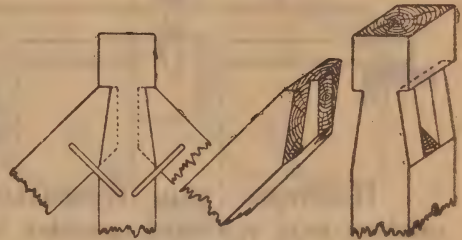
соединение стропильных ног с бабкой в том случае, если бабка не имеет на себе прогона, и фиг. 266 — если сверх головы бабки укладывается прогон.
